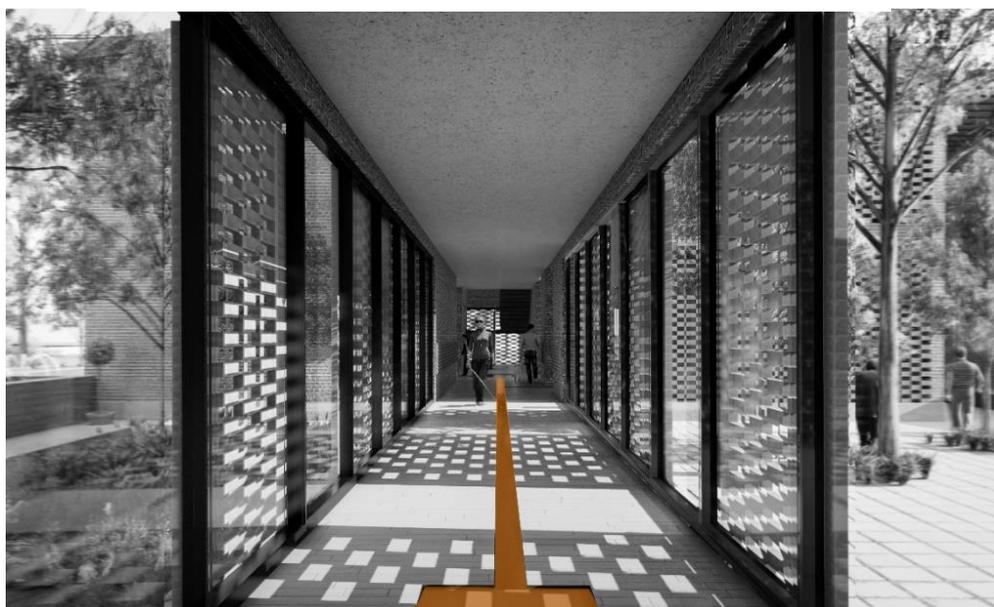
Vista 3d de elemento lineal para bastón guía.
